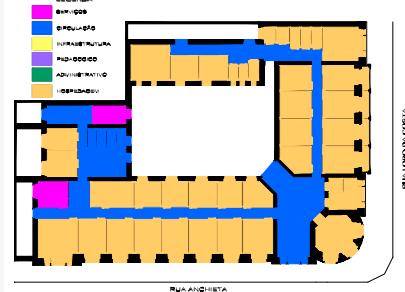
Zoneamento / Planta Baixa 4º Pav.
